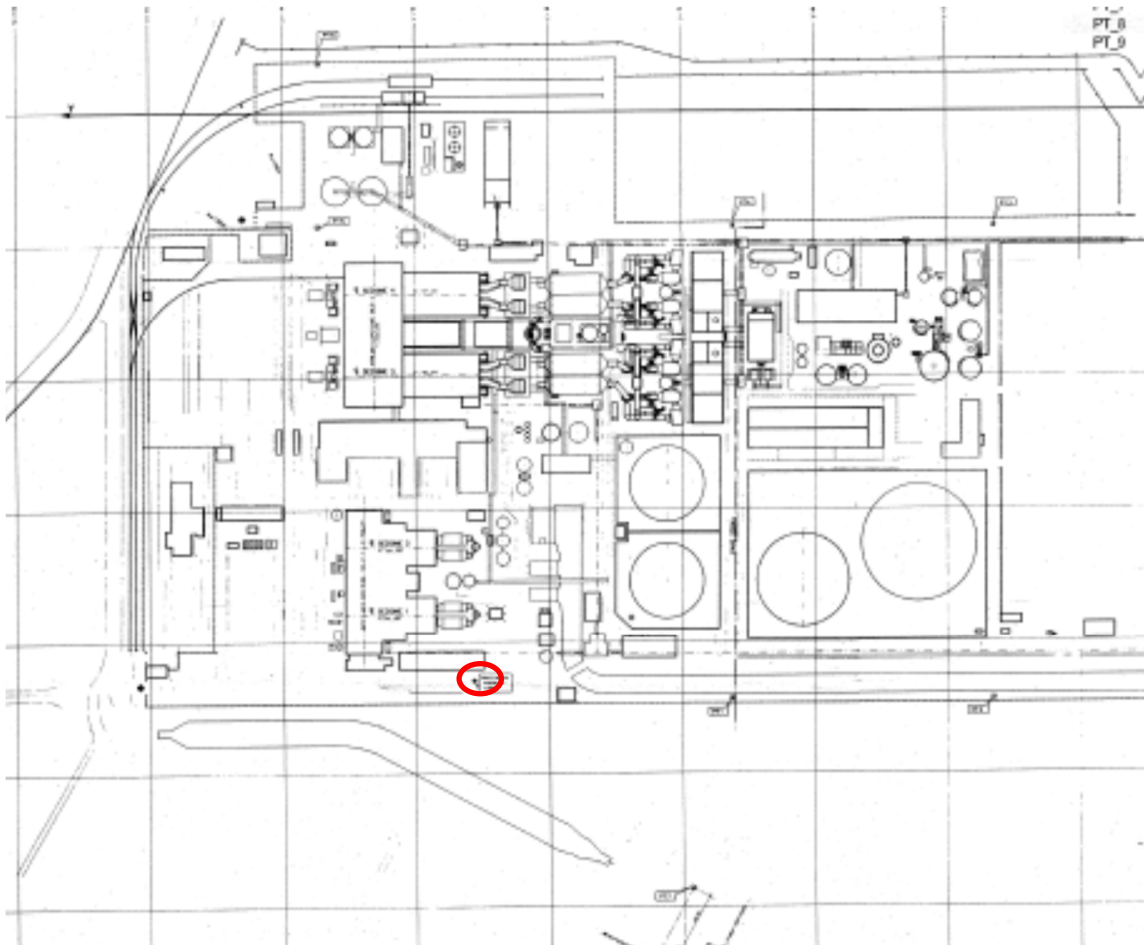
pianta dell'esistente Centrale di Fusina con ubicazione del caposaldo POZZO B
